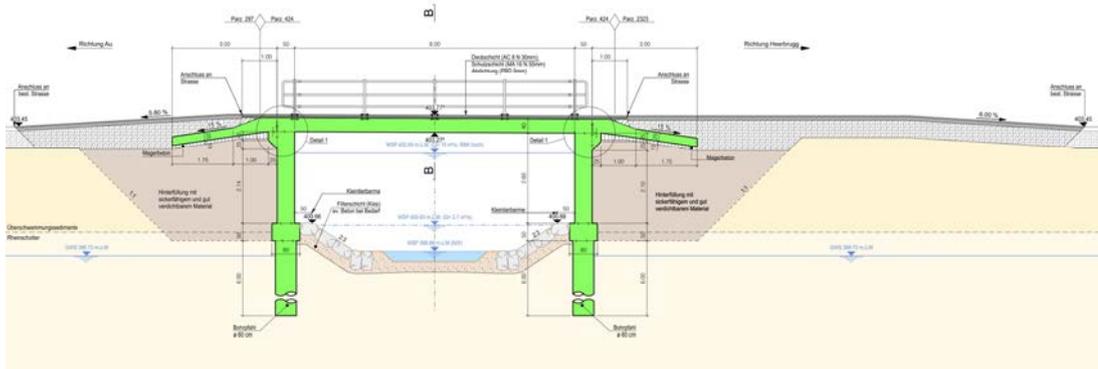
Vertikale Linienführung der Brücke Werkstrasse, Ächeli
